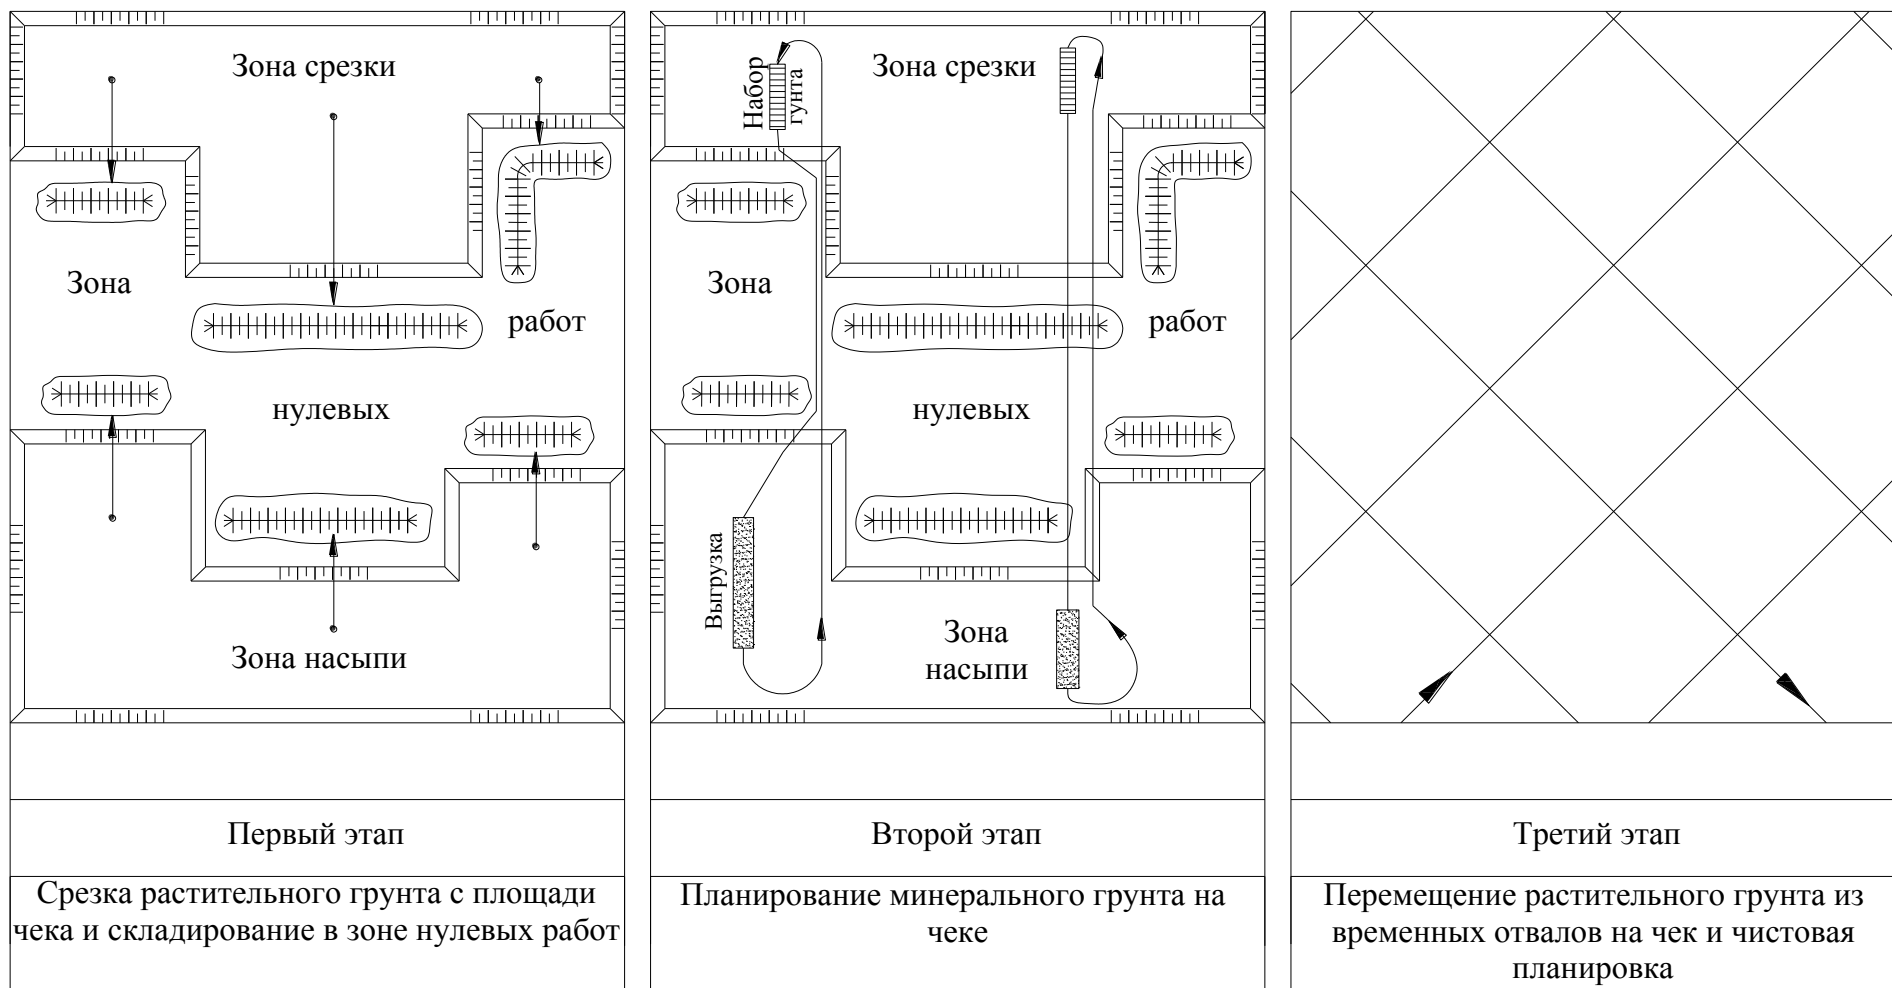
Способ планировки со сплошной срезкой растительного грунта
